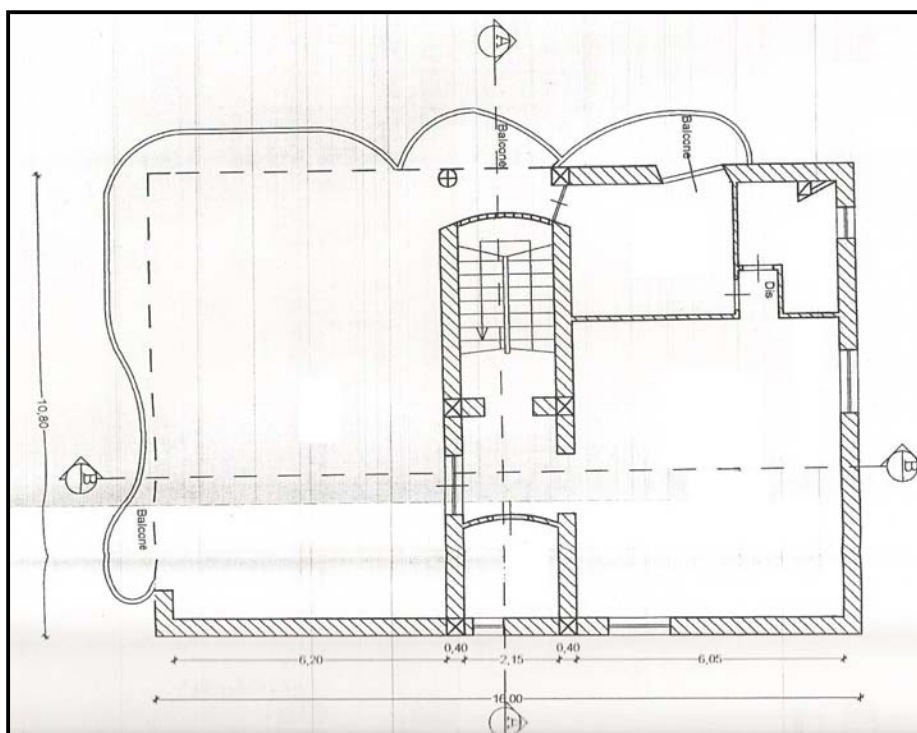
Appartamento al piano sottotetto: planimetria dei locali.
